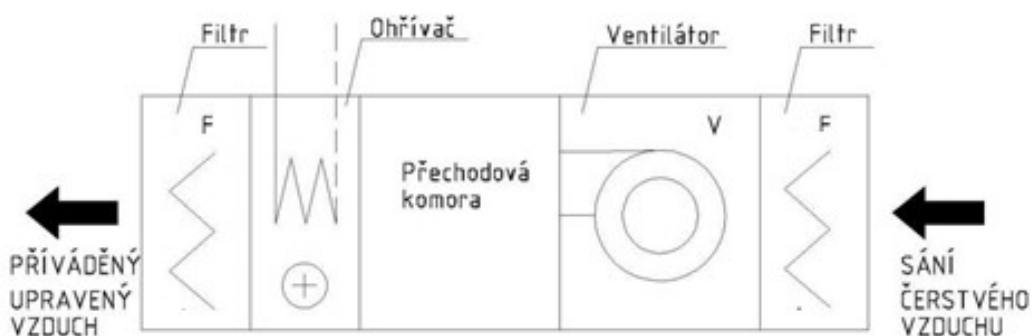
Vzduchotechnická jednotka pro instalaci v exteriéru
